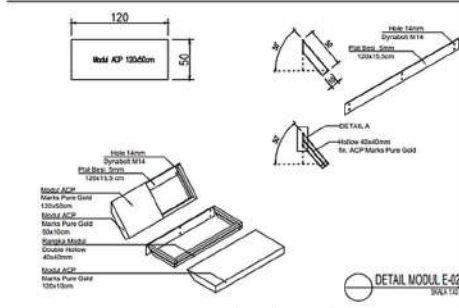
7 Sistem Peneduh Horizontal dan Detail Pemasangan pada Orientasi Barat
